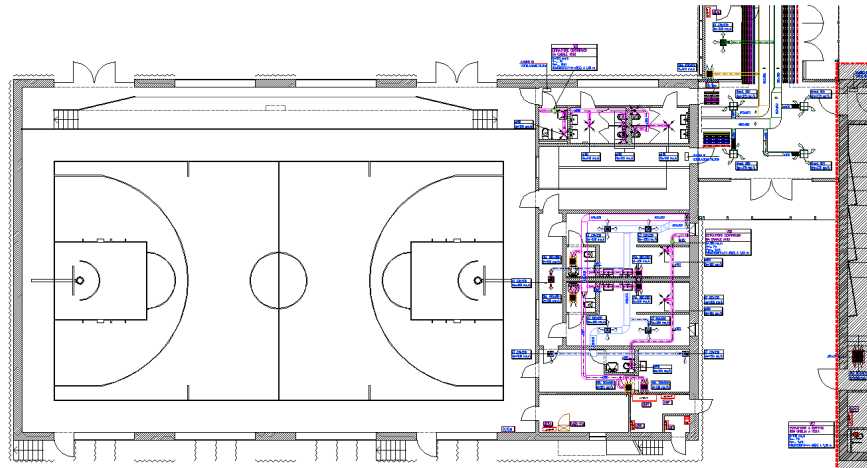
Pianta piano primo scuola: VMC in progetto
